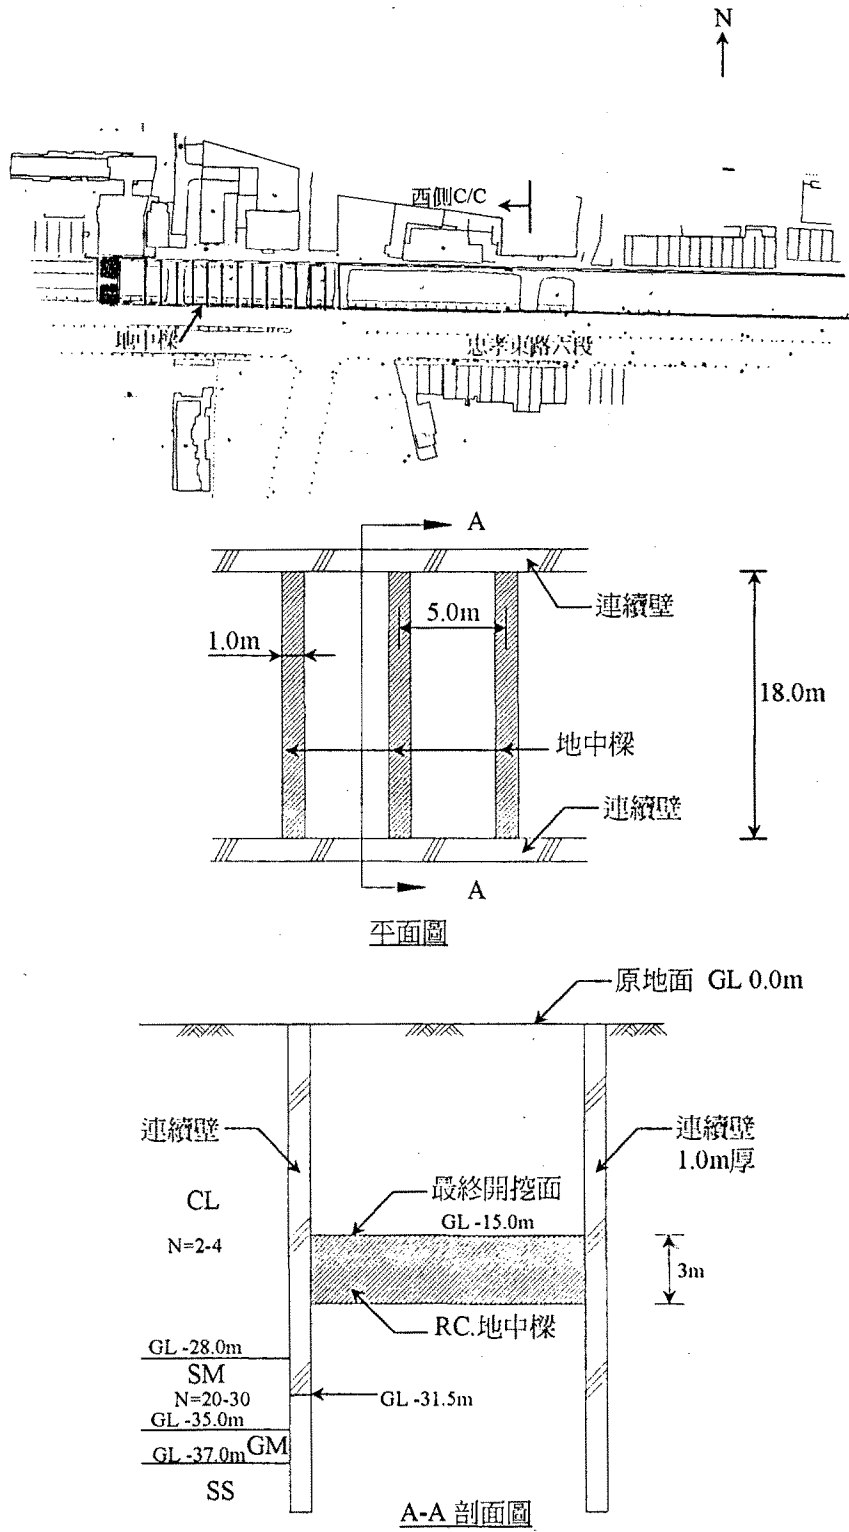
南港線CN259C標支撐穩定設施平面及剖面圖(地中樑)
